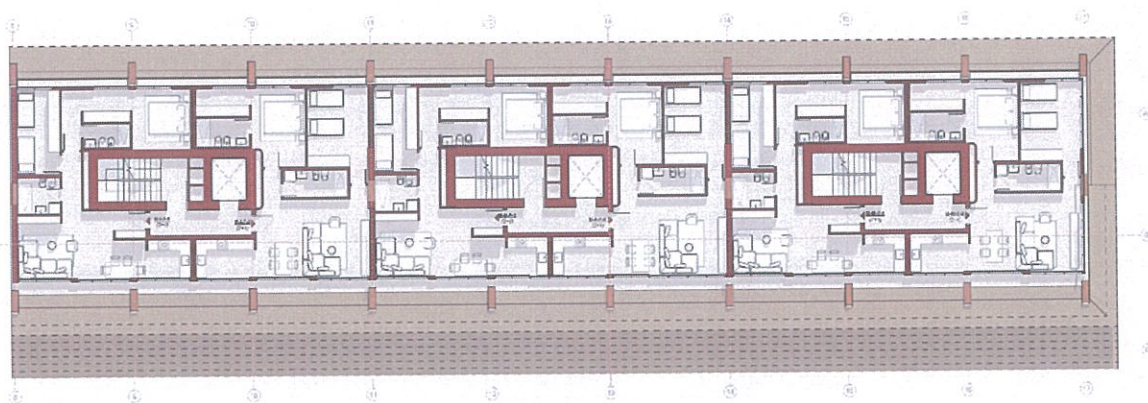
Planimetria e mobiluar e katit +7 Objekti B
